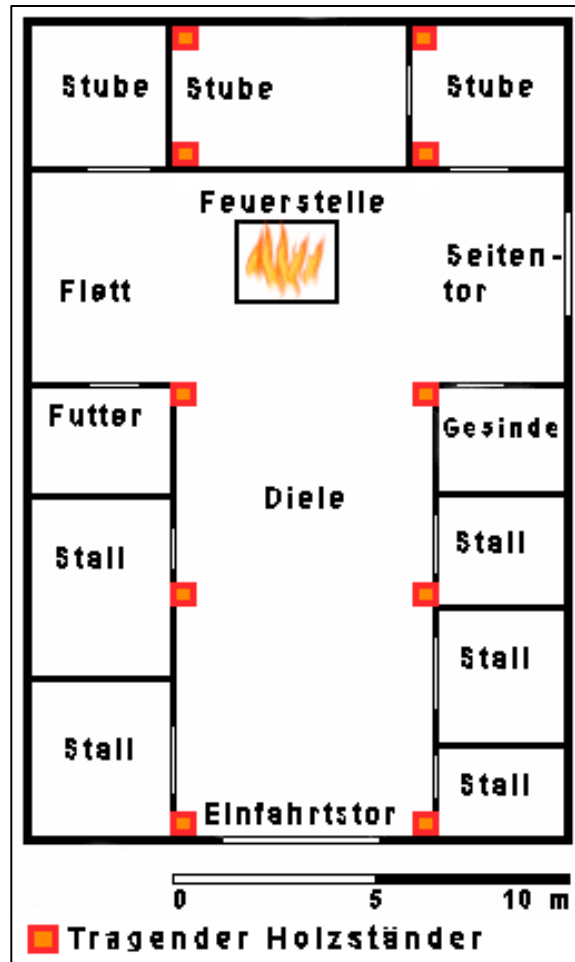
Generalisierter Grundriss eines Hallenhauses.¹¹
